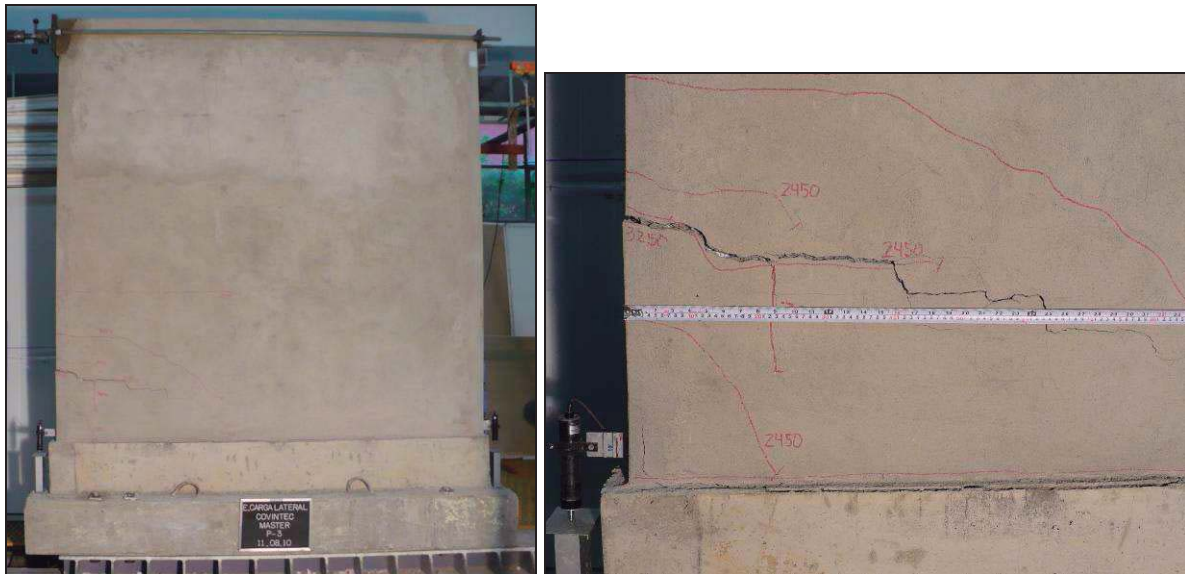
Vista general del montaje del ensayo de carga horizontal al panel.
